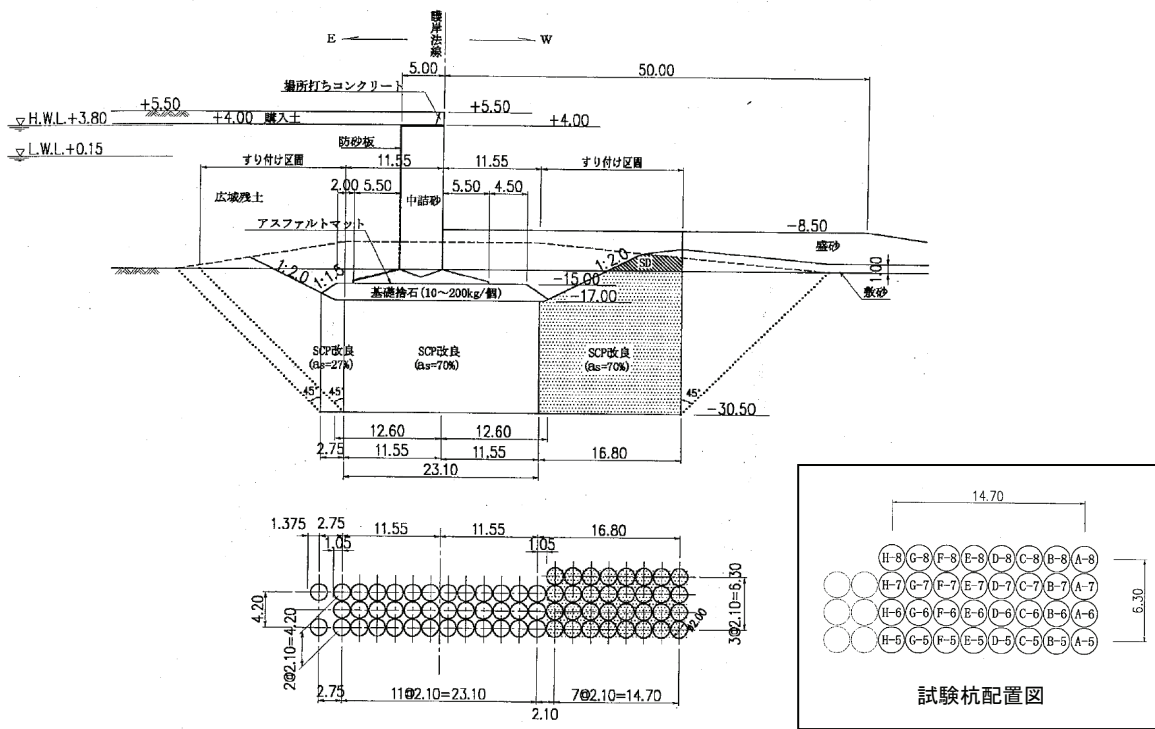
試験施工断面および SCP 平面配置²⁰⁾
